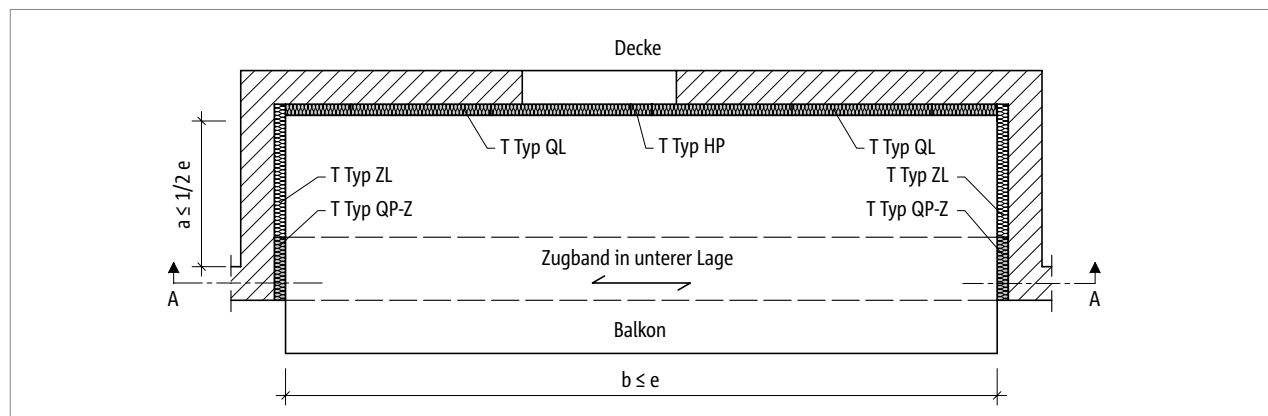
Schöck Isokorb® T Typ QP-Z, QL: Grundriss Loggia
